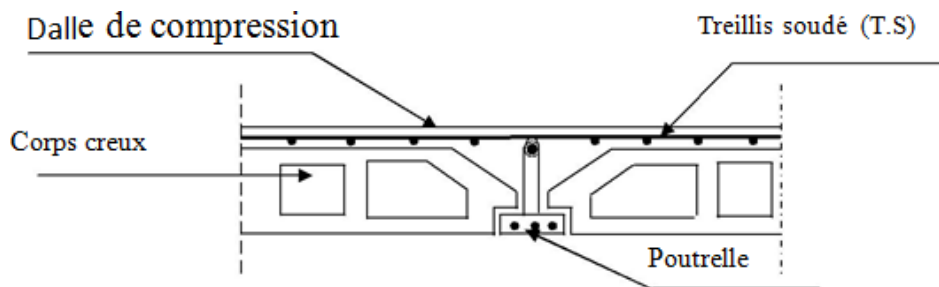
coupe transversale d'un plancher en corps creux.
